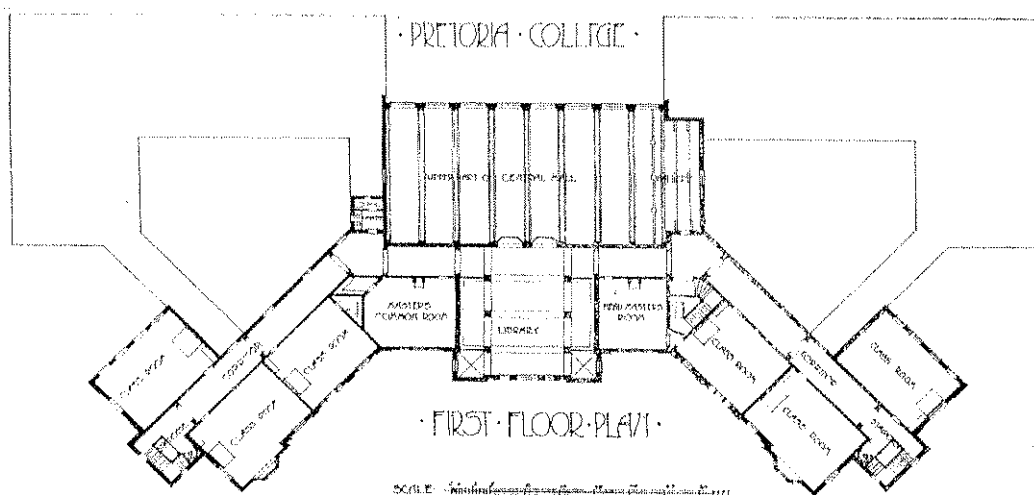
Hoofgebou : eerste vloer plan . Oorspronklike uitleg.
